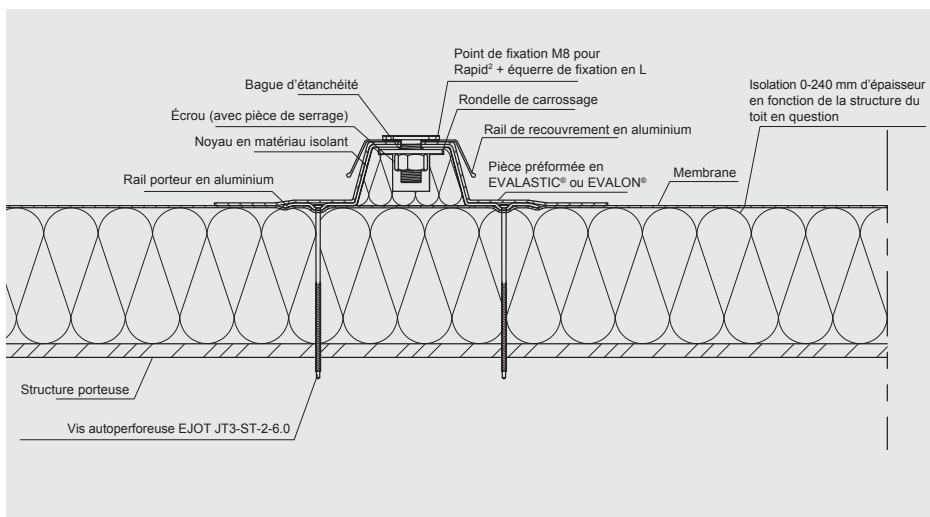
Rail de montage EVATEC® Solar d'alwitra : montage simplifié sur l'étanchéité de toiture, fixation sûre à l'aide de vis de fixation
